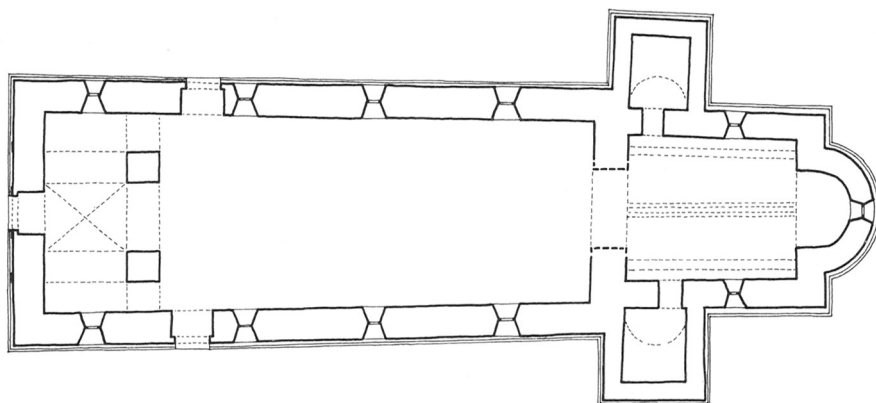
Rekonstrueret plan af Hansted kirke 1:300, KdeFL 1967.
